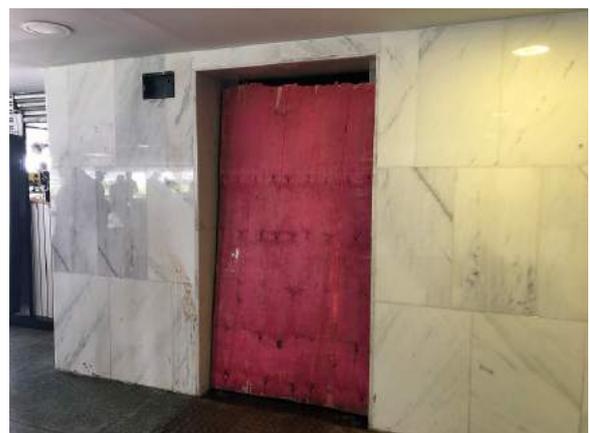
Vista de tapumes cobrindo as portas dos elevadores quebrados;
